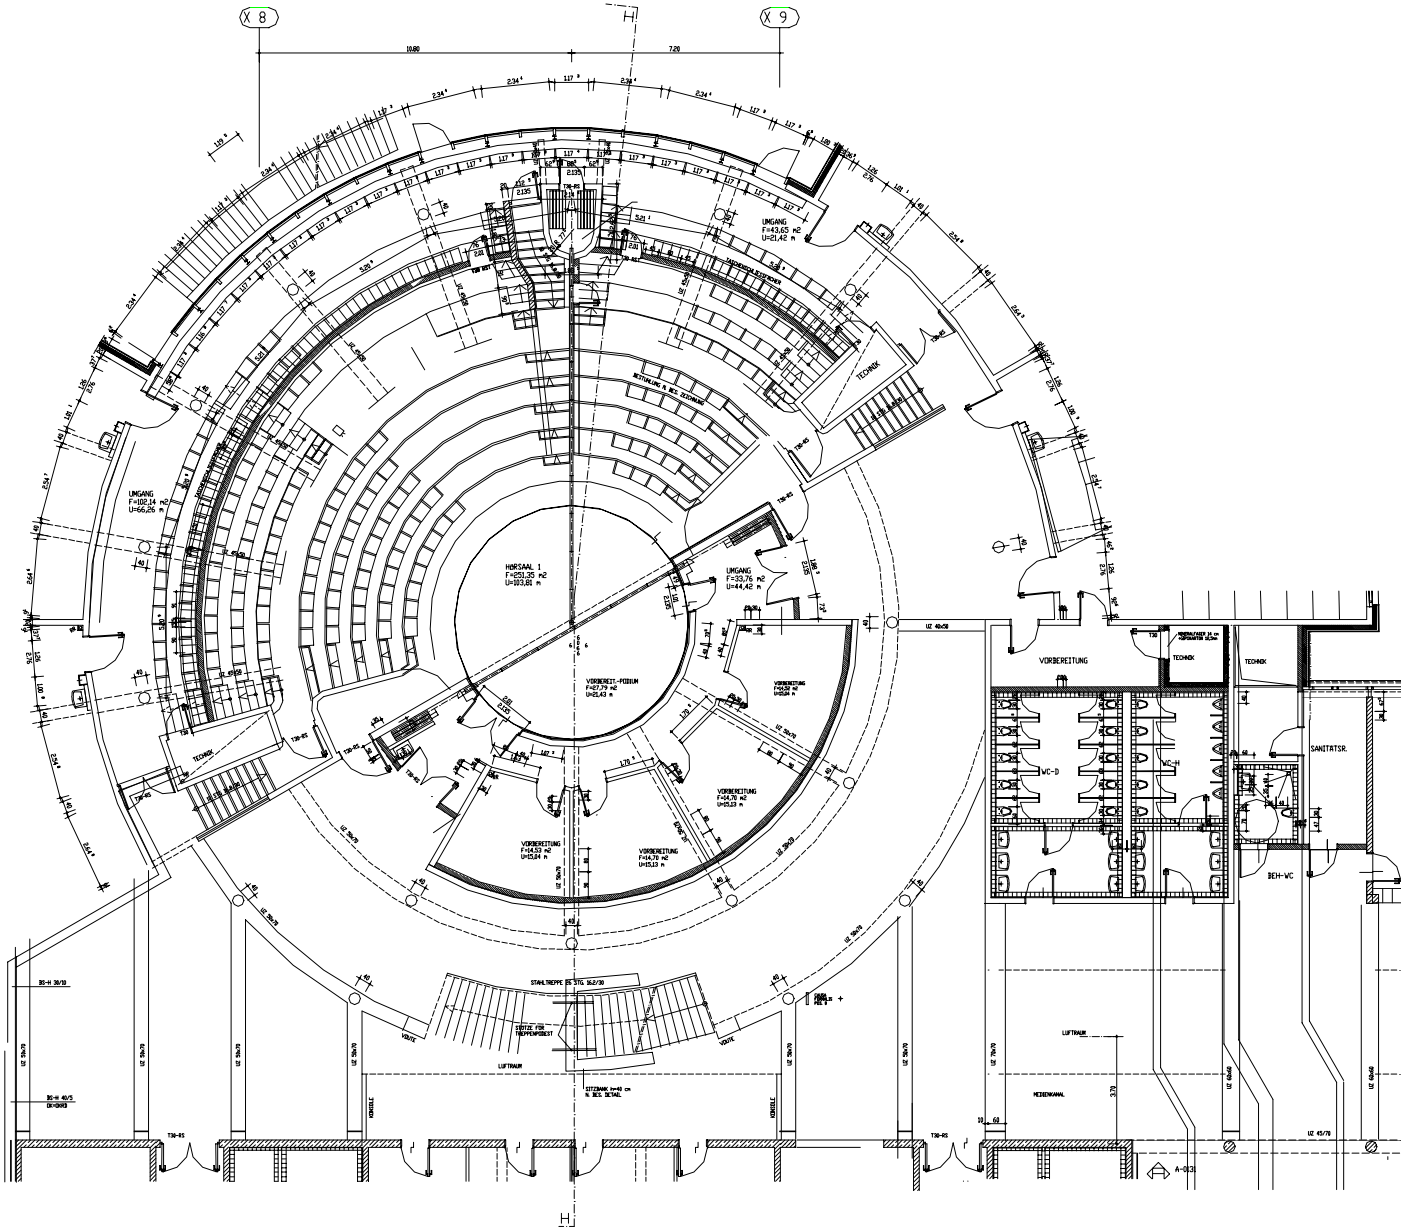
Grundriss OG (Maßstab ca. 1:250)
